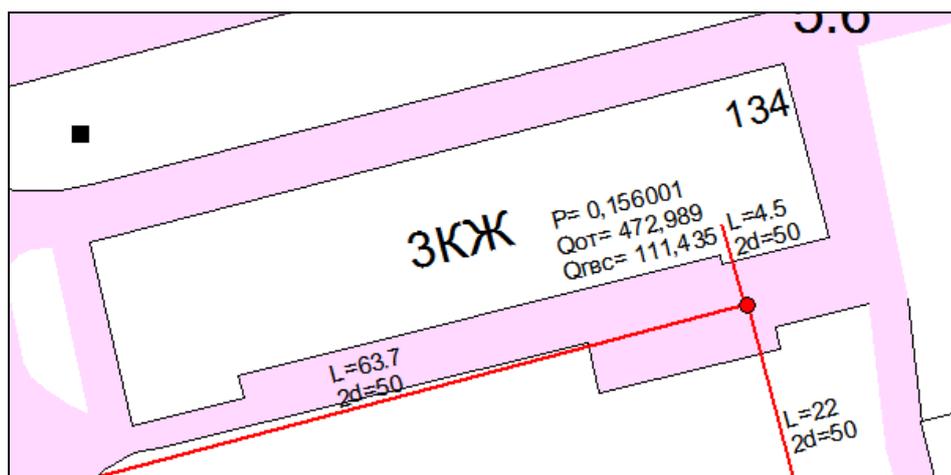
Обозначение тепловых нагрузок абонента.
